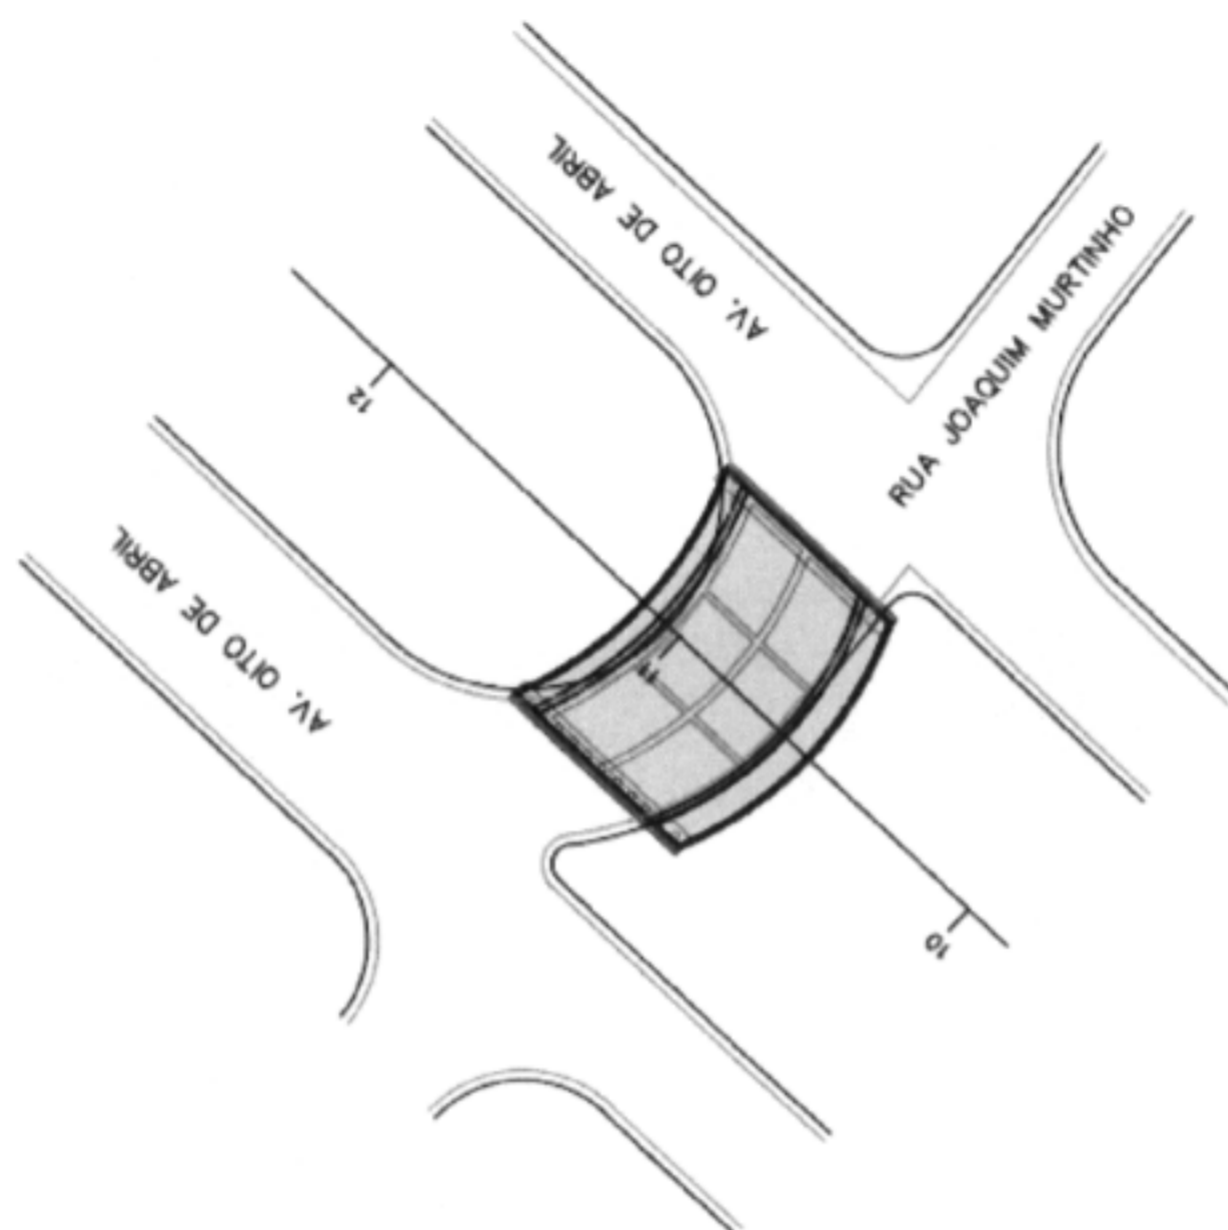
Detalhe do Retorno da Rua Joaquim Murtinho.
